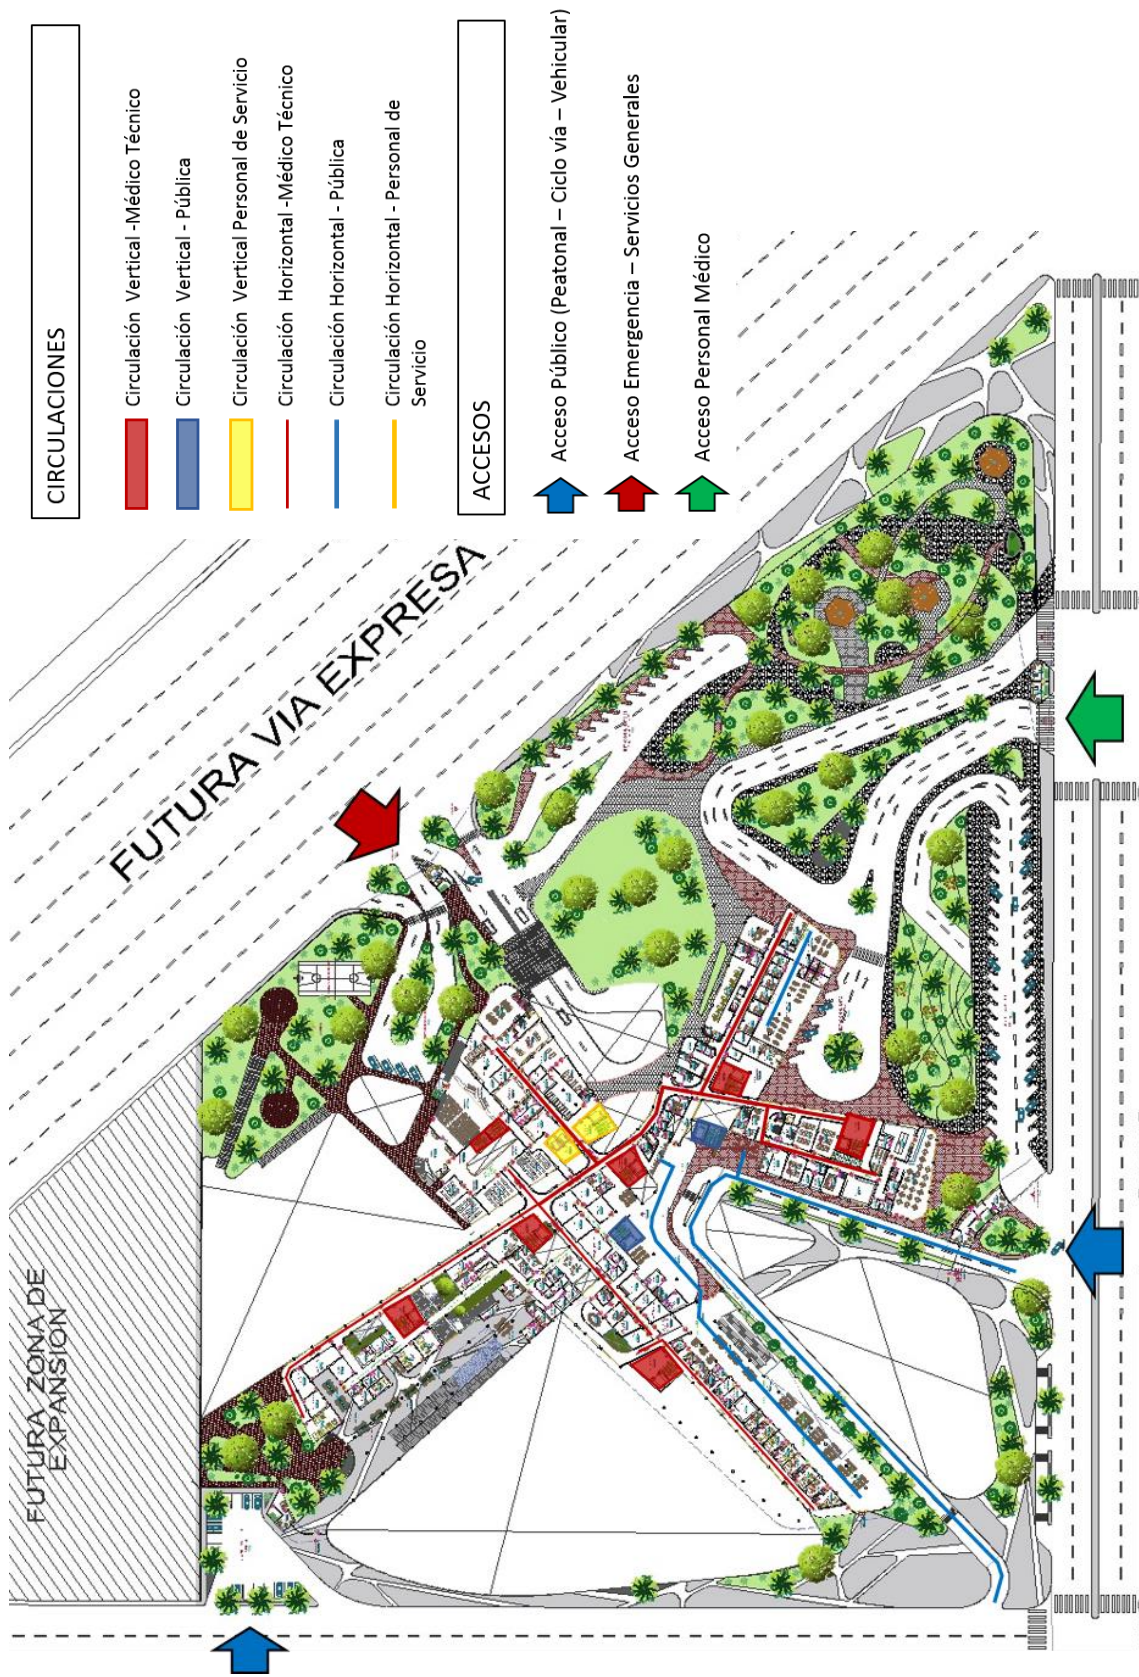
Circulación de Primera Planta de la Propuesta Arquitectónica.
